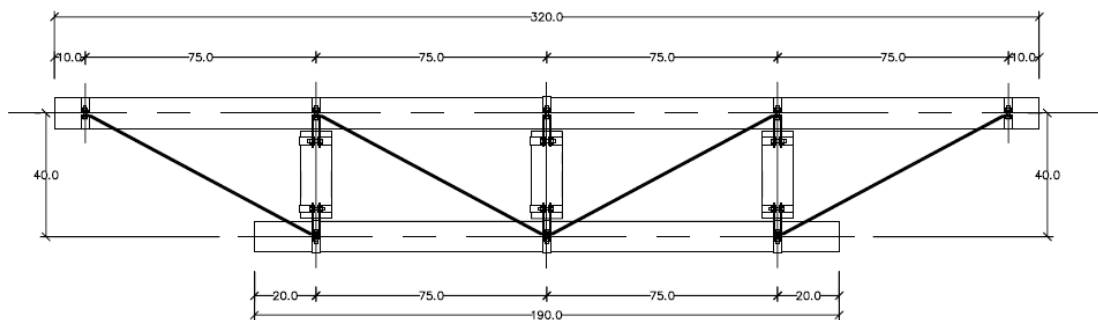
Vista en alzada del prototipo de guadua. (Dimensiones en centímetros)
